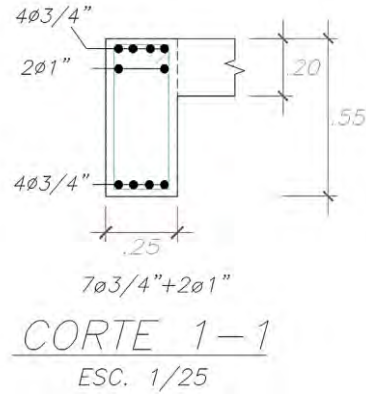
Detalle Corte 1-1 de Viga VP-01
